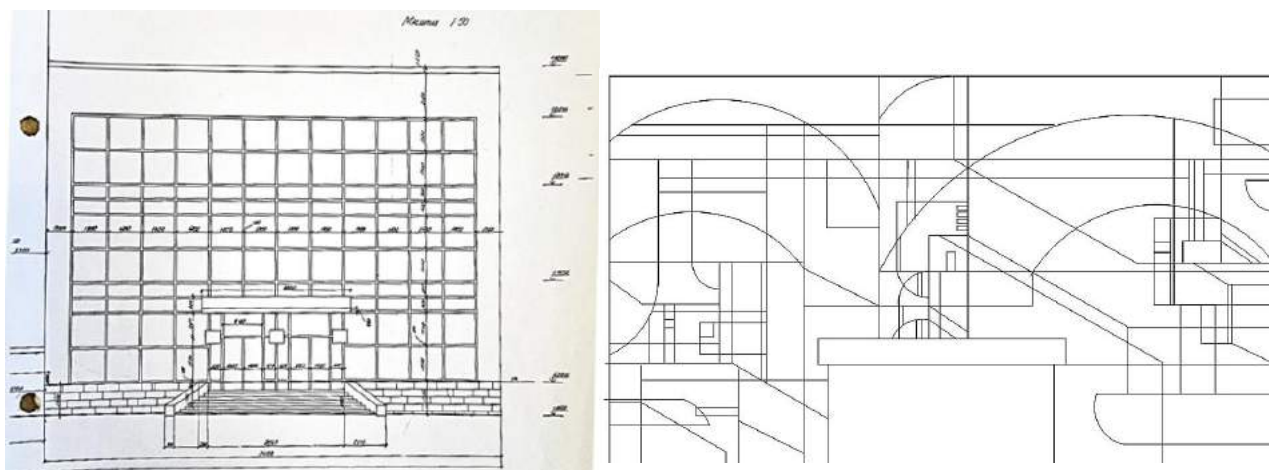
Переход от анализа схемы фасада к графическому поиску пластического мотива, а от него – к разработке цветowych эскизов витража на фасаде здания первого корпуса ННГАСУ.
